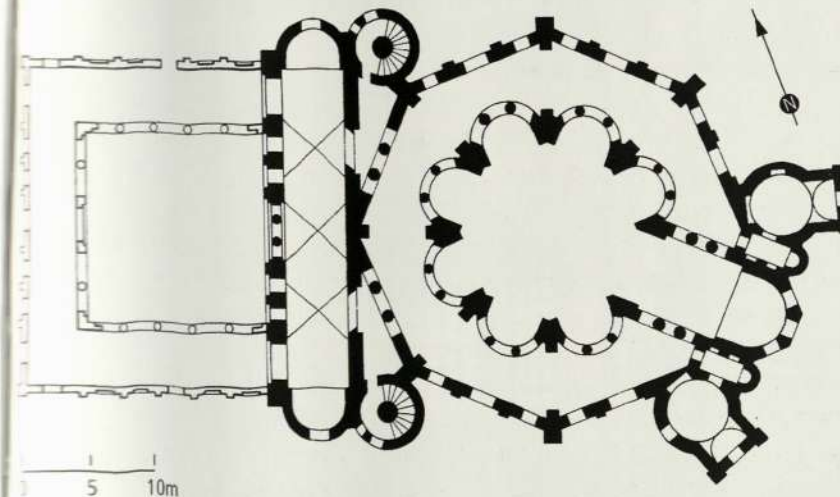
Ravenna, S. Vitale, Grundriss
